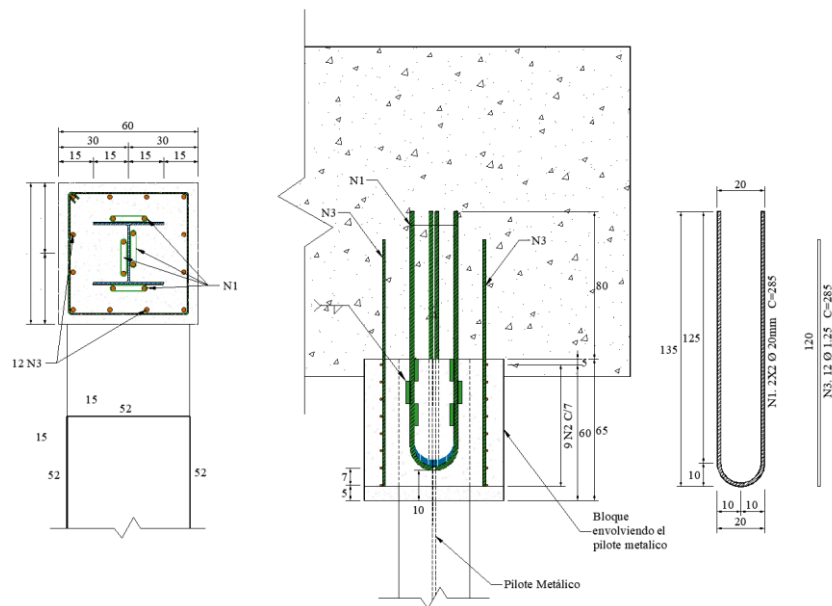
Unión de pilote de acero con un elemento de concreto
